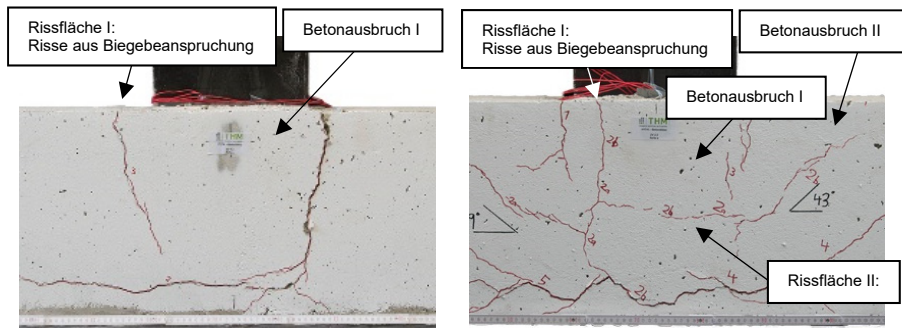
Links: Rissentwicklung im Prüfkörper VR3-ZV-1.4 (unbewehrt) ; rechts: Rissentwicklung im Prüfkörper VR3-ZV-2.2 (mit Dübel-, Rückhänge-, und Biegebewehrung)
